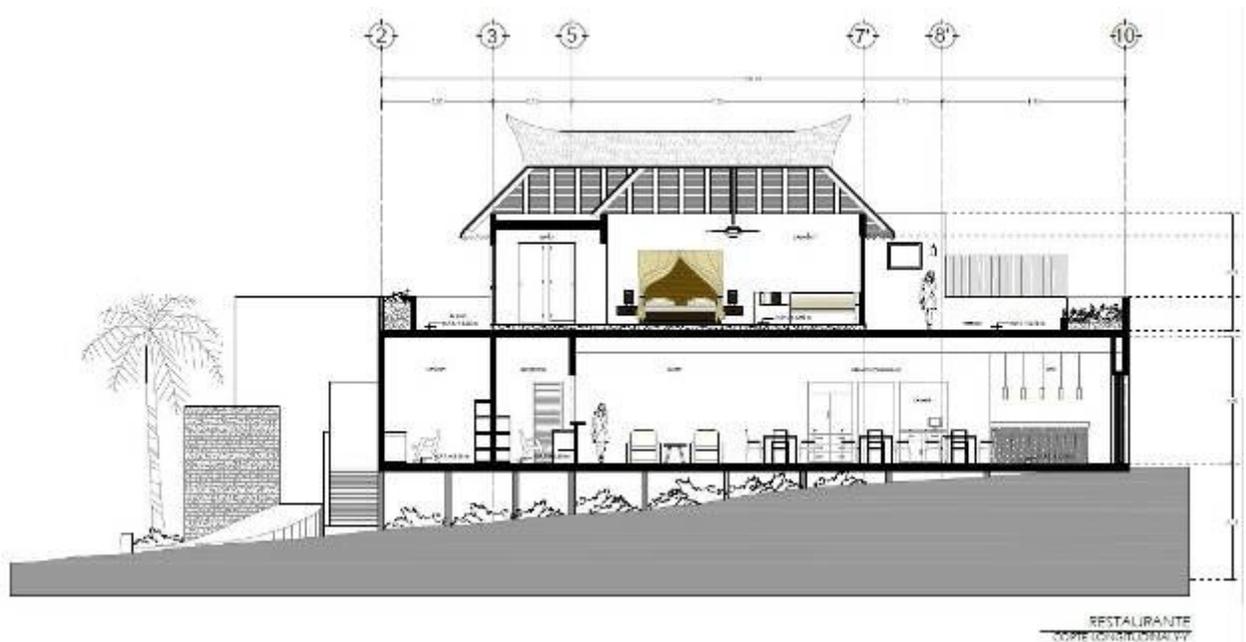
Corte longitudinal de Restaurante/Recepción, mostrando su estructura y distribución.
